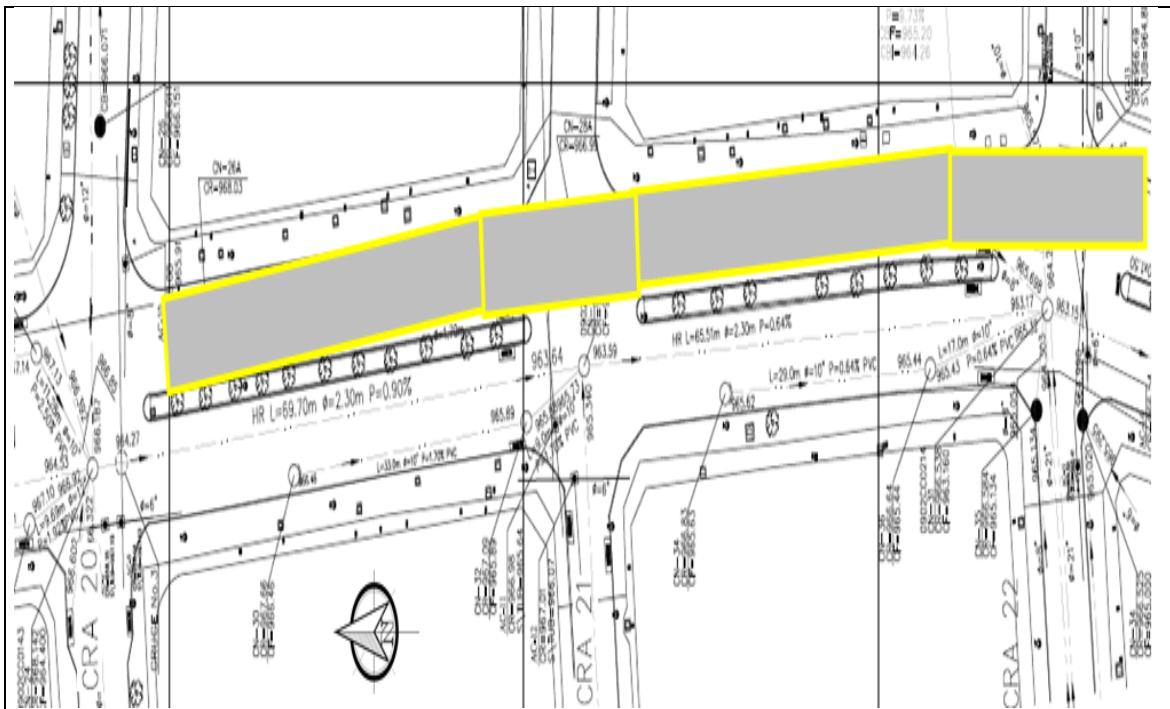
Pavimentación calle 11 entre carrera 23 y 22 costado oriental.
